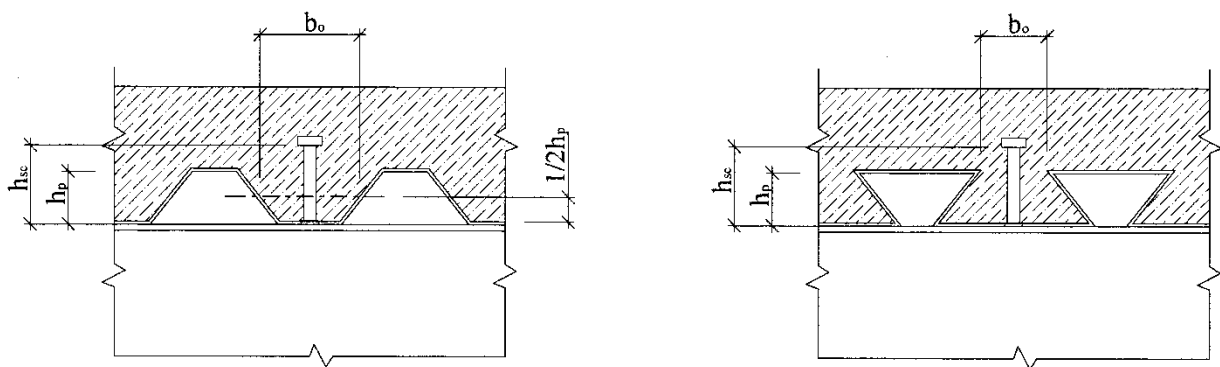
Плита с настилом, расположенным поперек балок
